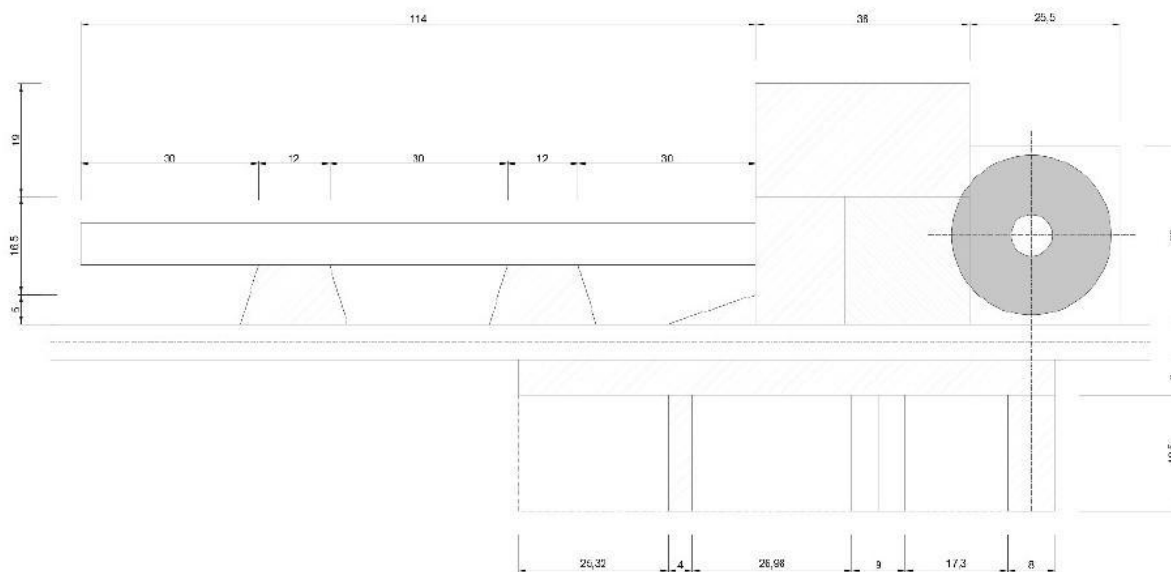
Planta cotada da plataforma de montagem das turbinas
